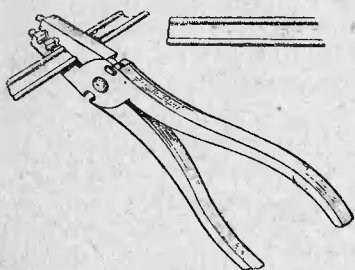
Перекусывание жил и перемычек провода марок ППВ и АППВ.
